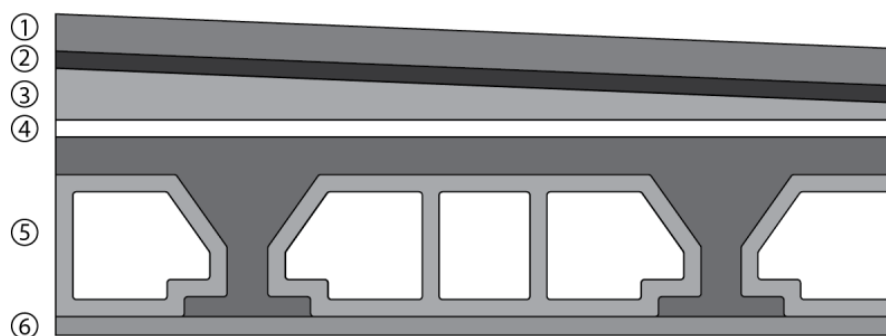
Section transversale d'un plancher terrasse (inaccessible)
